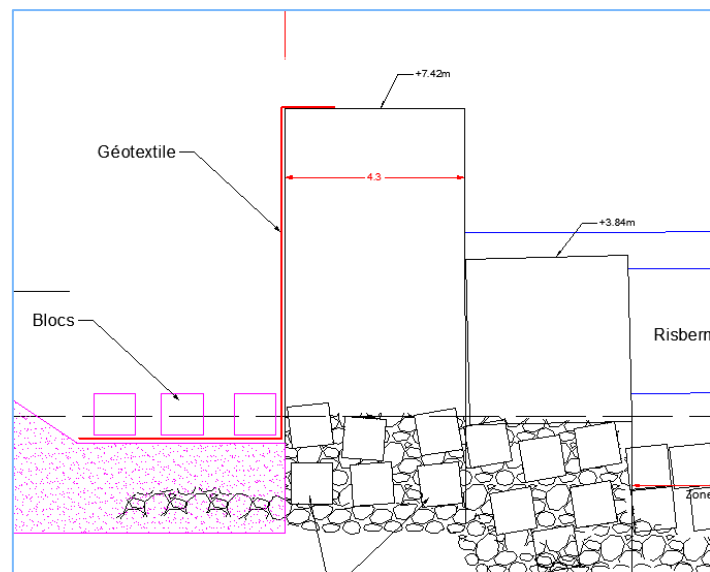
Plan de coupe des blocs stabilisateurs du géotextile
